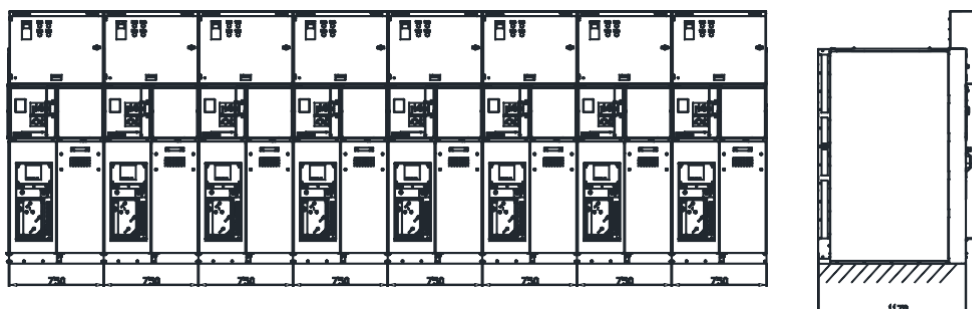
Layout orientativo – Cubículos da Subestação 02
